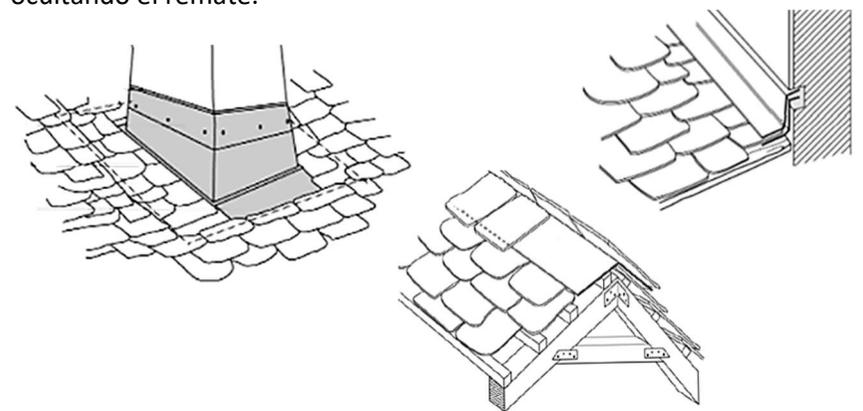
Refuerzo de estanqueidad en arranque de chimenea, en encuentro de cubierta paralela con muro y en cumbrera (Broto, 2005)
